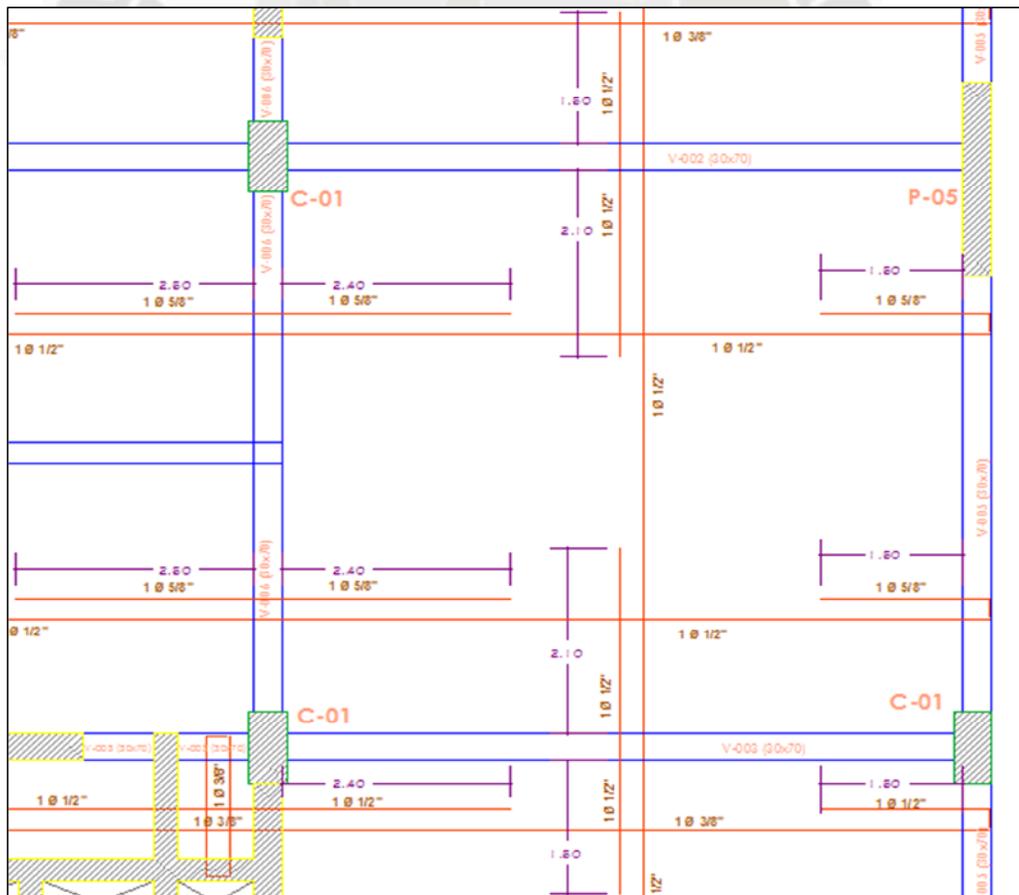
Distribución Final del Refuerzo en la Losa Aligerada Bidireccional Analizada.
